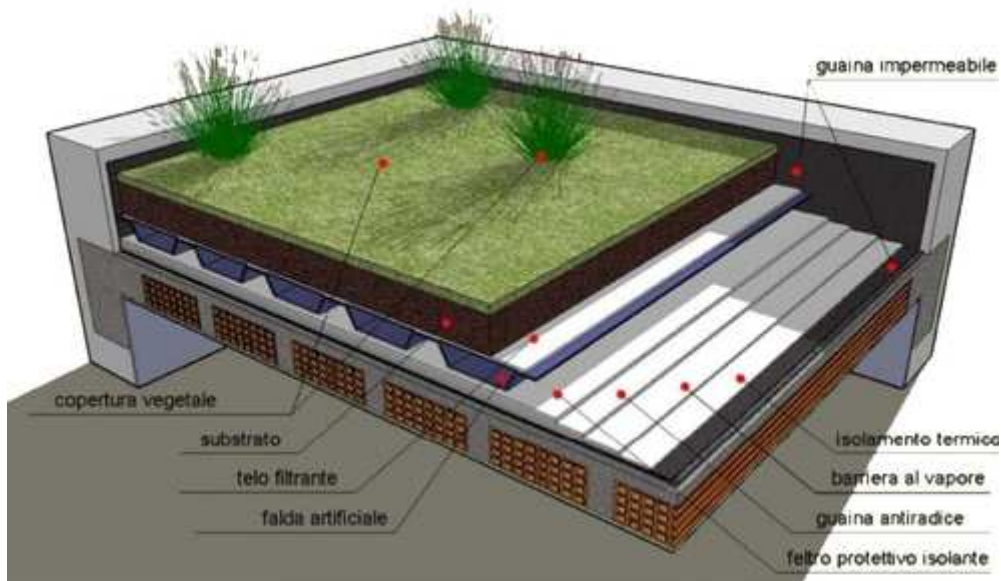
soluzioni per tetto verde e/o tetto di terra.
